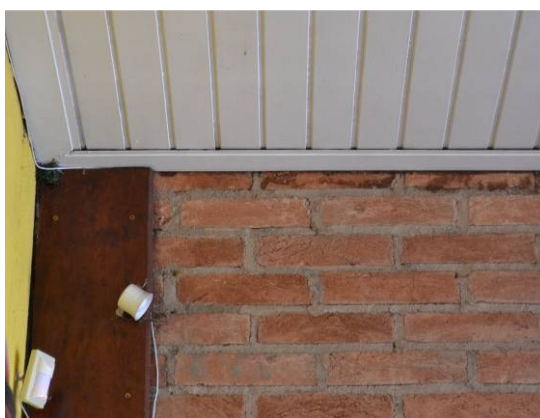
Detalhe dos tijolos aparentes em bom estado e forro de PVC.
